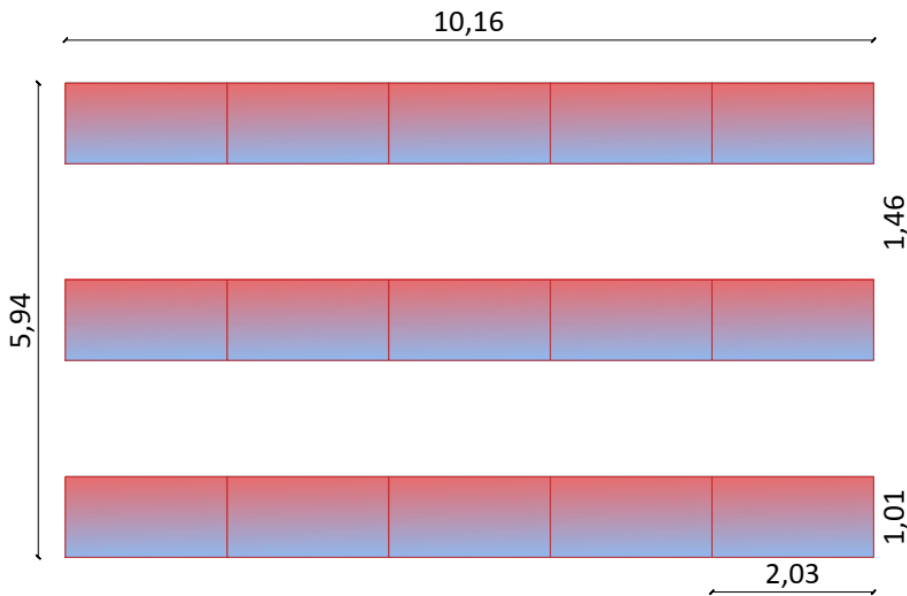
Medidas de ocupación de los paneles en planta cubierta.
